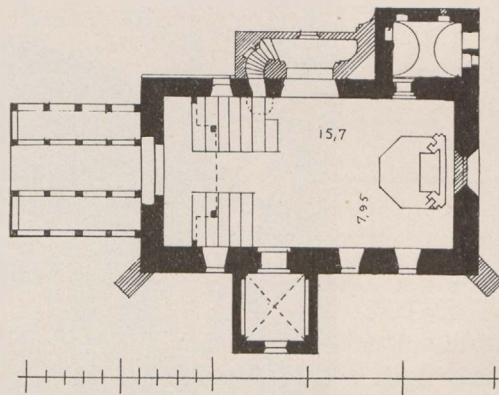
Grundriß der Kirche in Schönwiese. M. 1 : 400.
